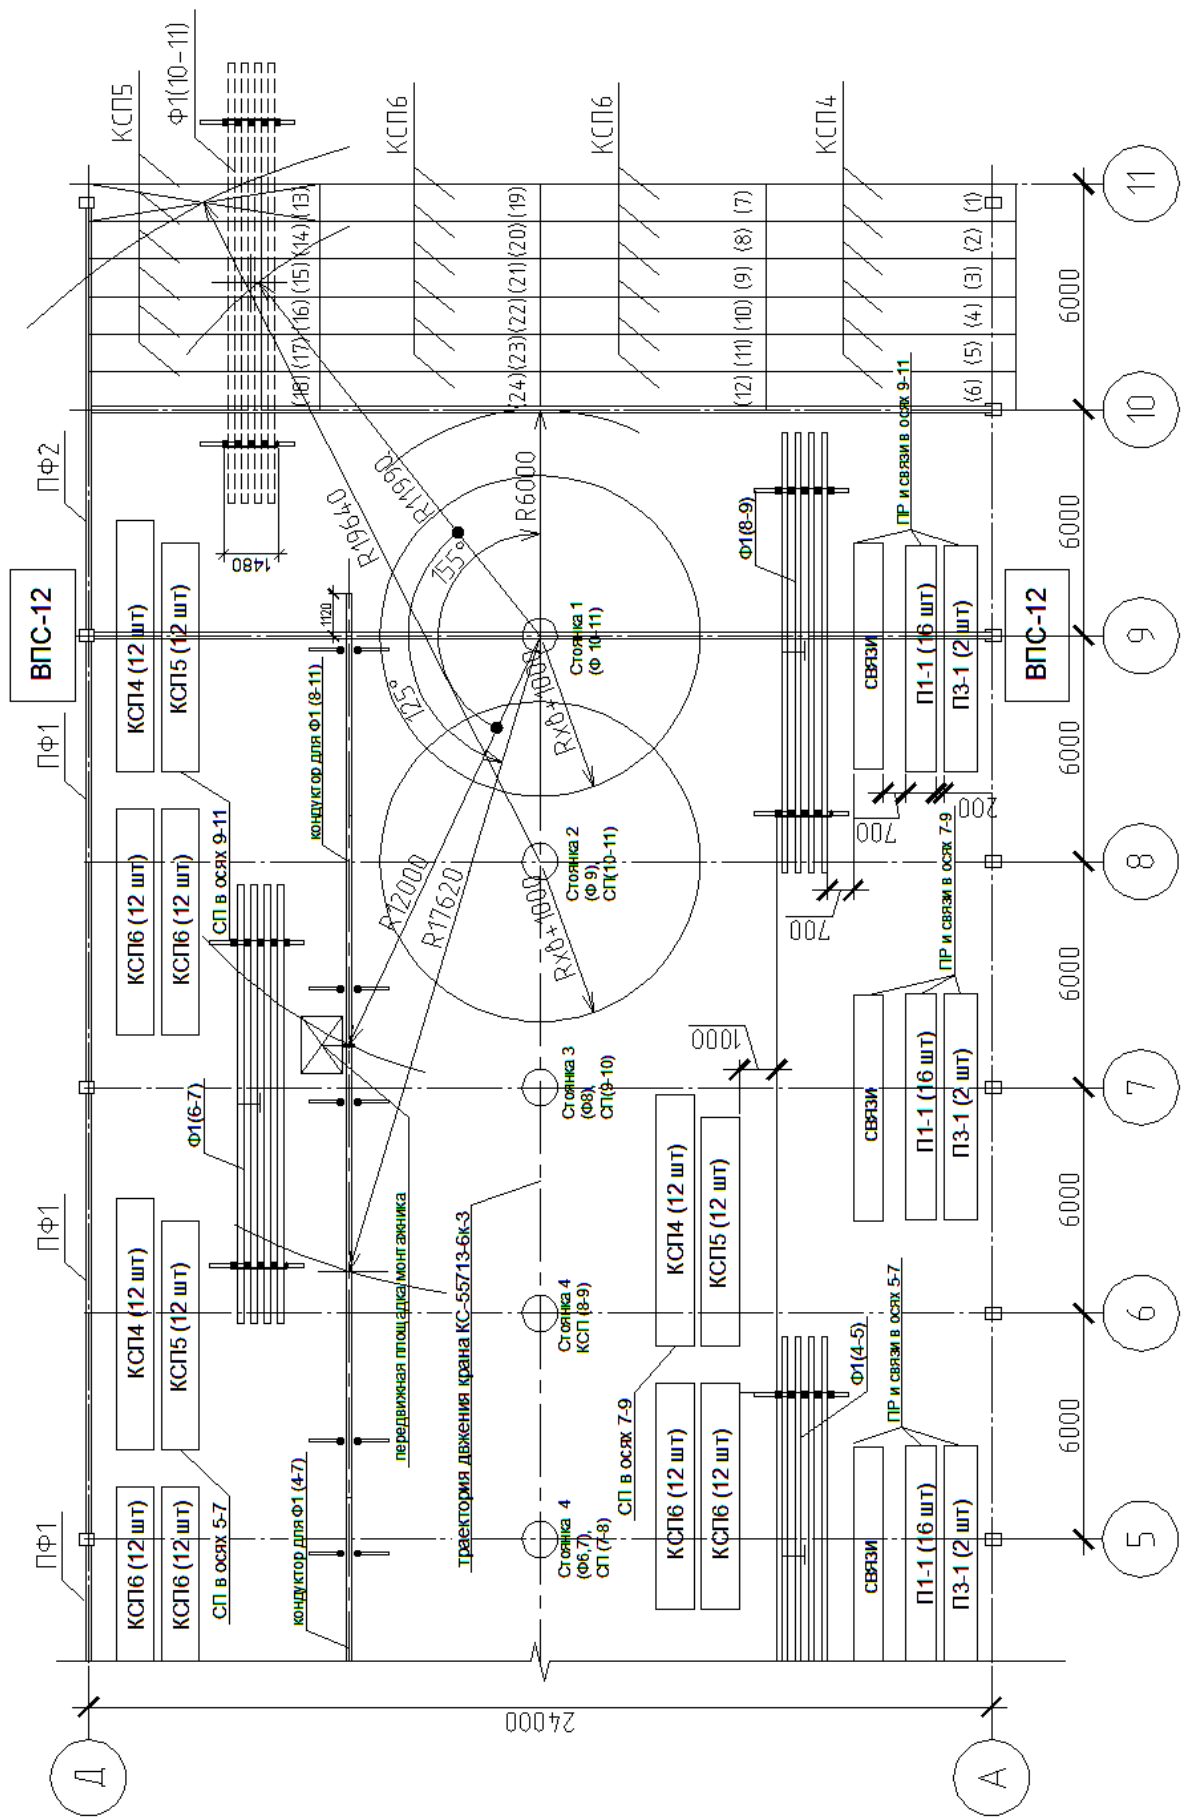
Схема монтажа стальных конструкций покрытия пролетом 24 м
